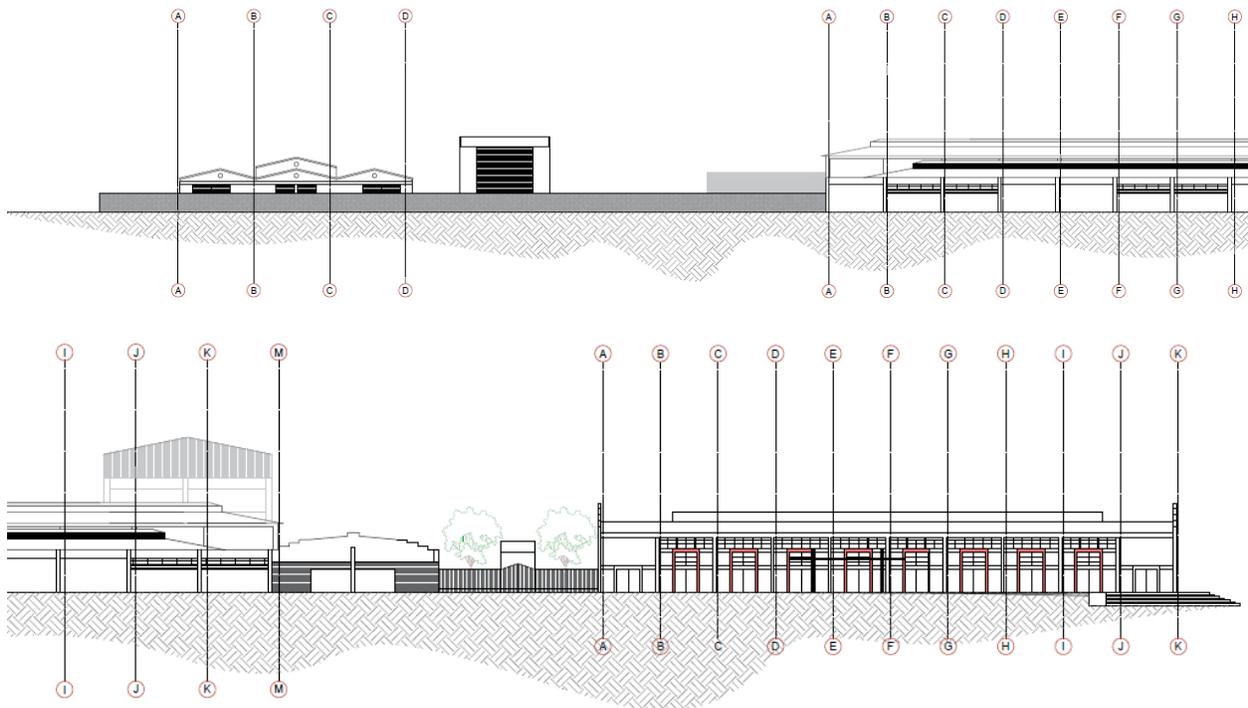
Planta arquitectónica Esc: 1:1000. Fuente: Imagen propia.
